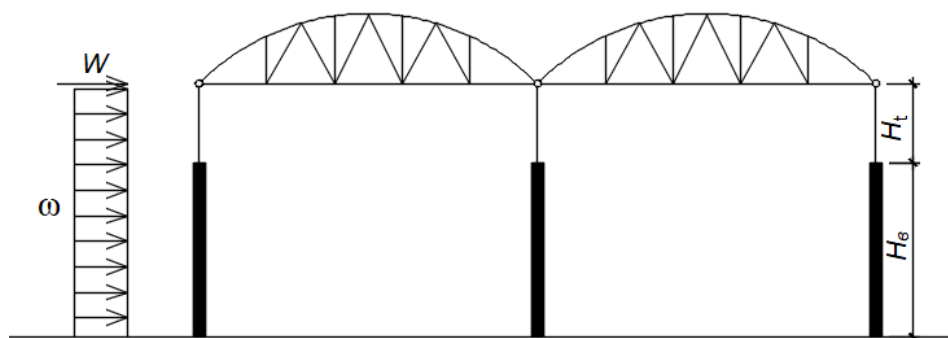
Схема поперечної рами в розрахунках стін будівлі з пружною конструктивною системою
